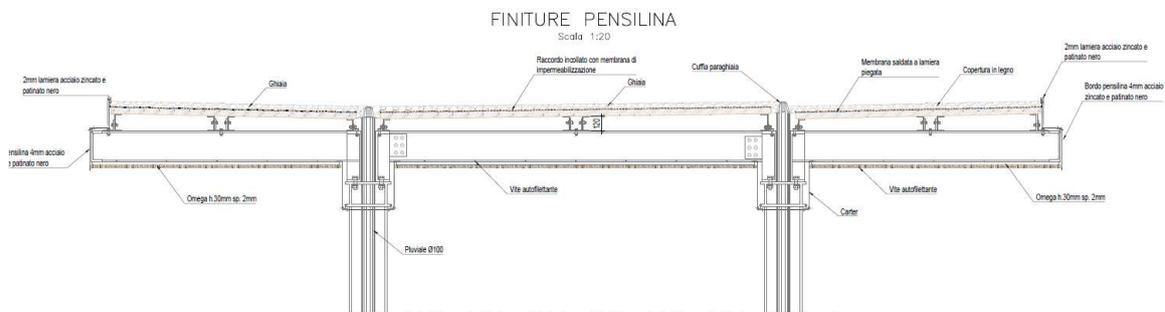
Dettaglio finiture copertura – pensilina a doppia falda
